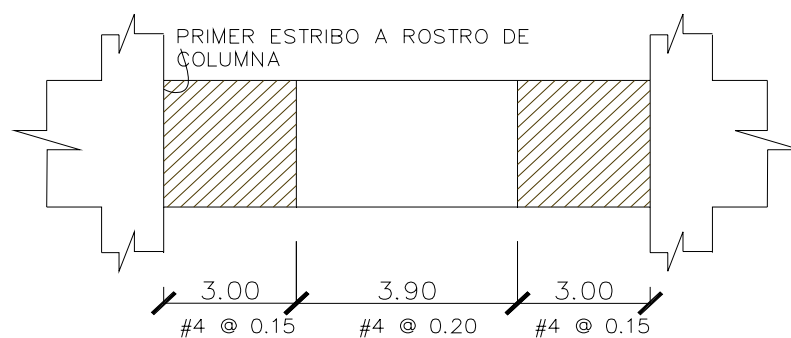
Diagrama de zonas de empalmes de refuerzo en vigas y losas de la ACI.
